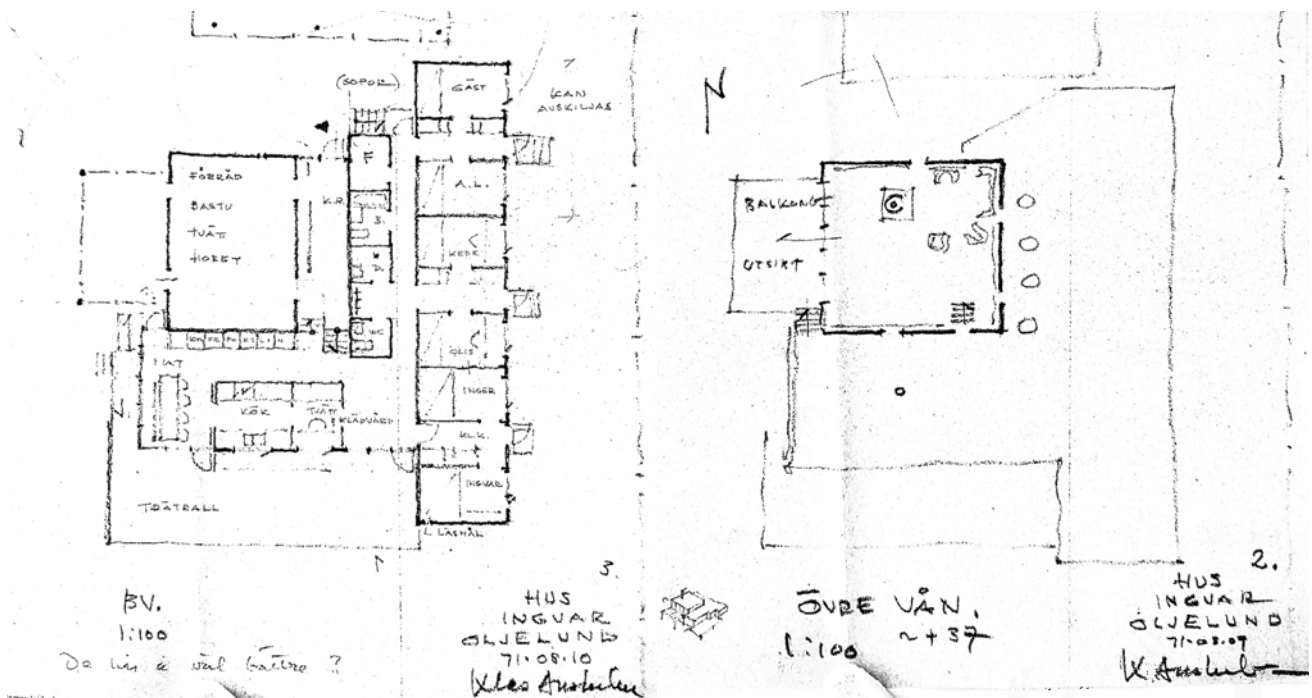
Villa Oljelund. Primeros planos. 10 de agosto de 1971. Planta de acceso. e.1/100. A mano alzada. Arkdes.
